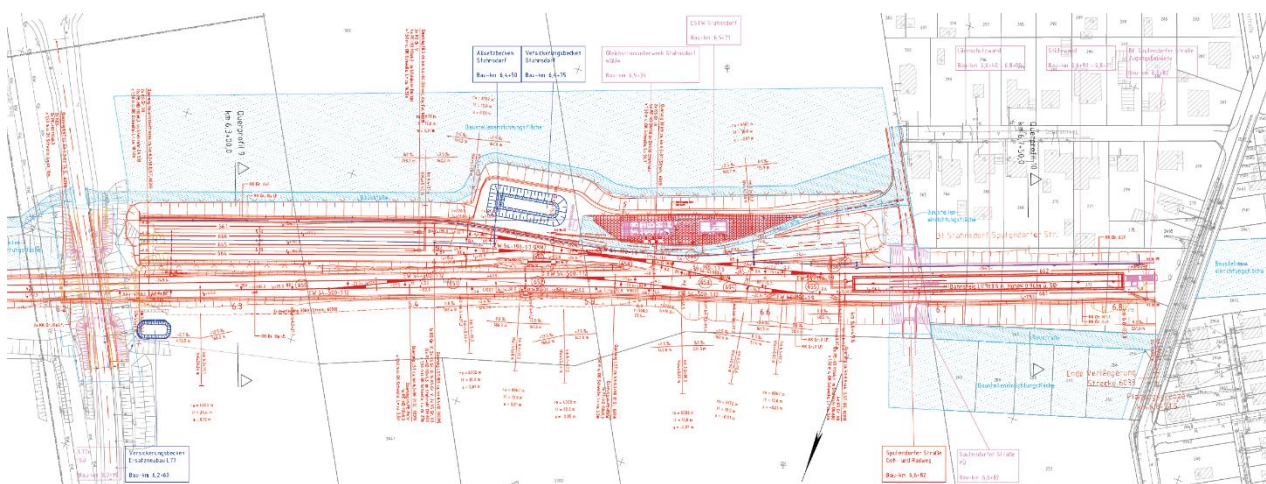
Aktueller Planstand Lageplan S-Bahnhof Stahnsdorf zwischen Sputendorfer Straße und L 77n (Originalmaßstab 1:1.000, Plan nicht geordnet!). Quelle: DB InfraGO AG
